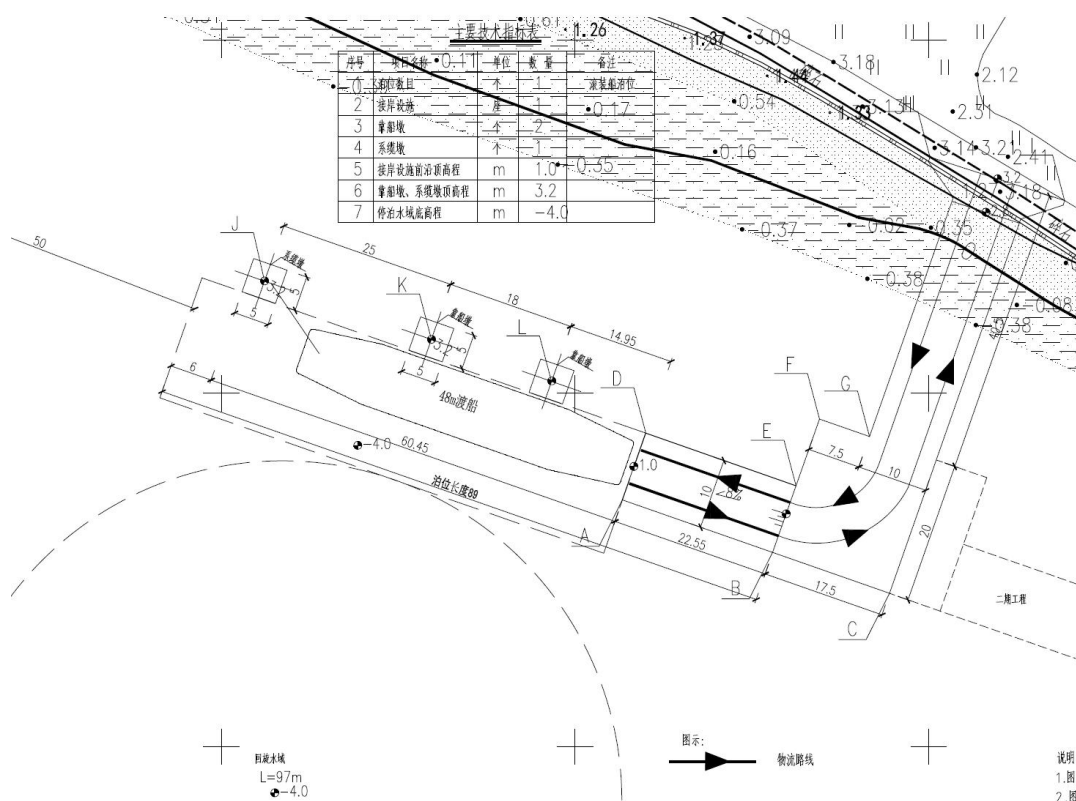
穿鼻岛侧滚装码头平面布置图
